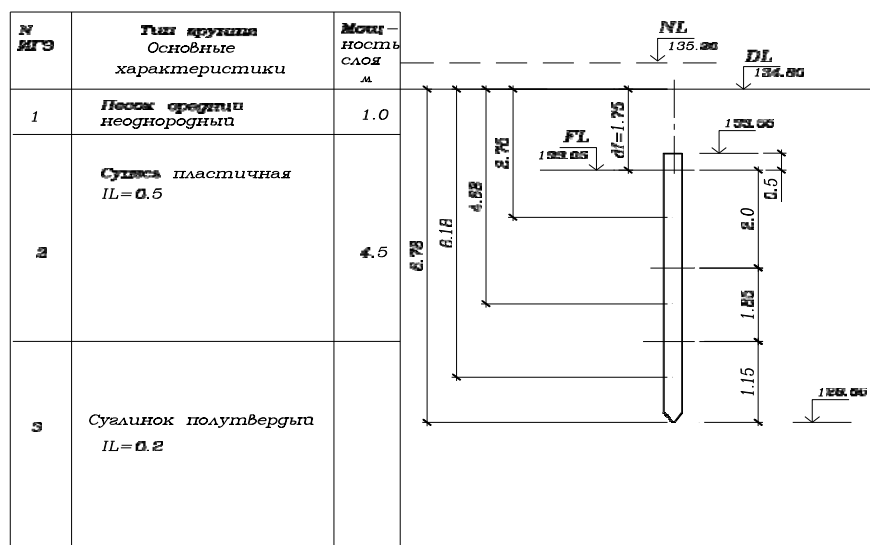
Расчетная схема определения несущей способности сваи по грунту
